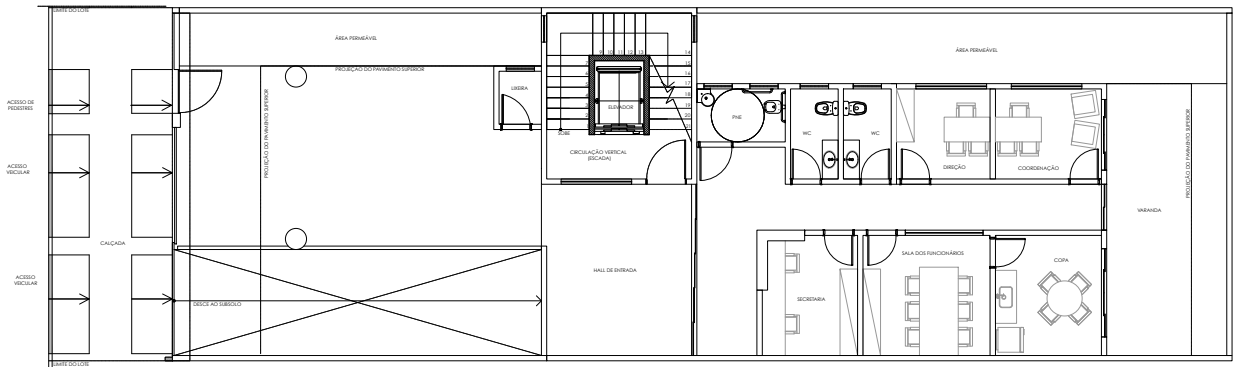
Projeto: Planta-baixa do Pavimento tipo (1º e 2º andar)
